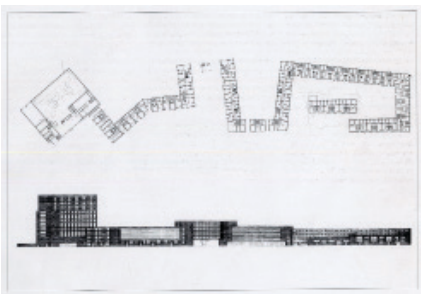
Pianta e prospetto del complesso Tegel Sud di Hans Kollhoff
